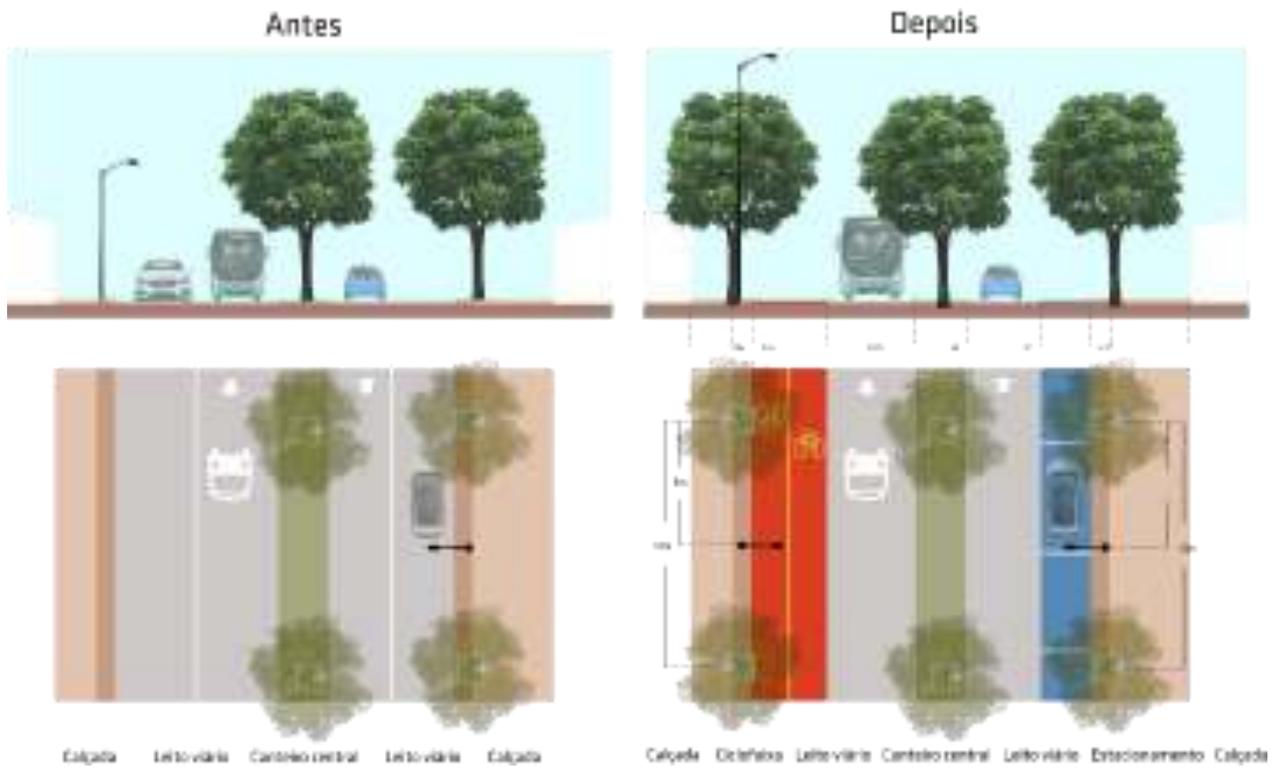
Proposta para a Seção O, Rua Jorn. Deolindo Barreto. Fonte: Architectus.
